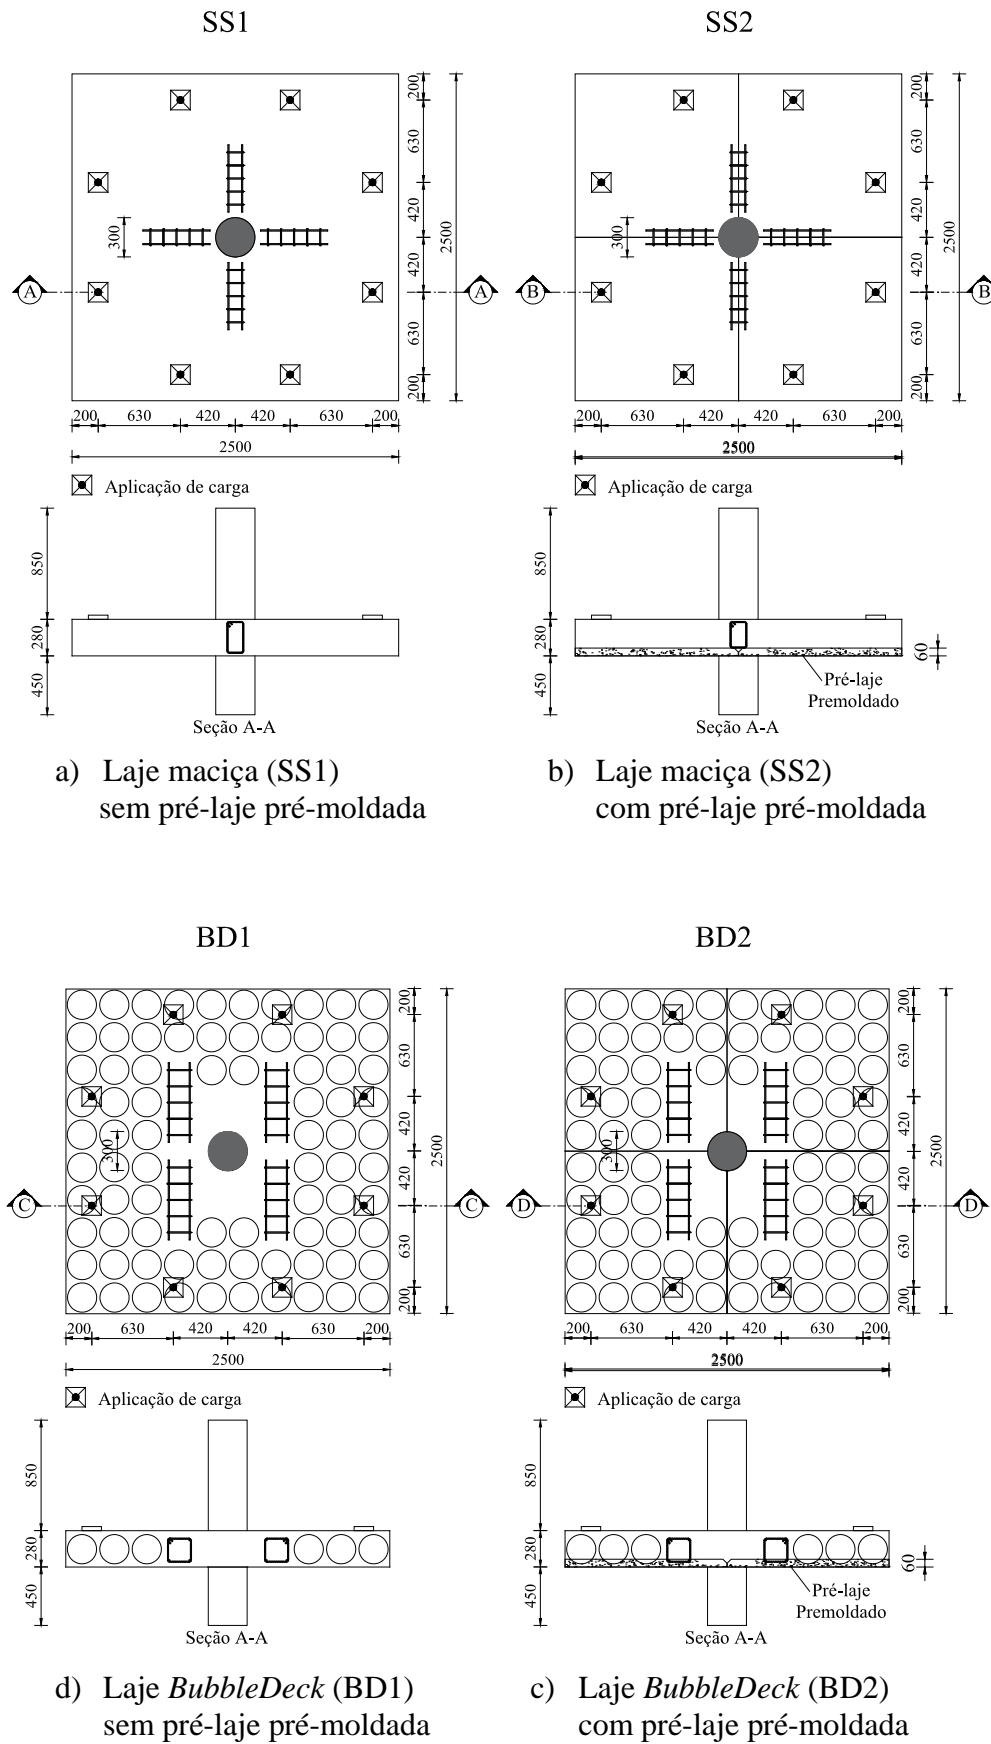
Geometria dos modelos locais (cotas em mm)
